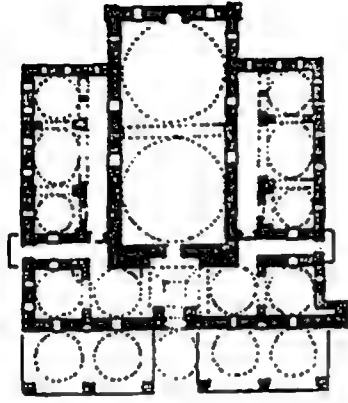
المسقط الأفقي لمدرسة قوجه سنان باشا .
